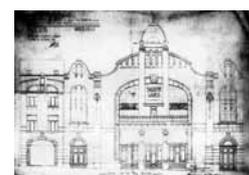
Plan de façade de l'autorisation de construire du 5 avril 1913¹
